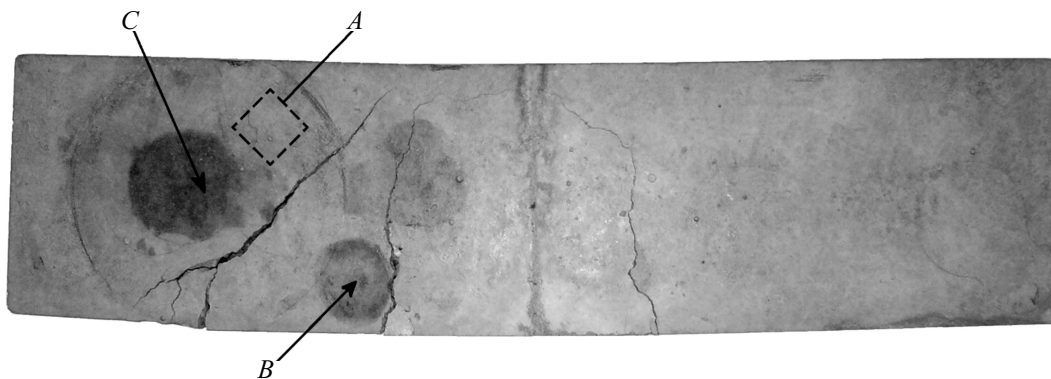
Фотография бетонной балки, армированной стеклопластиковой арматурой, после проведения испытаний на изгиб.
